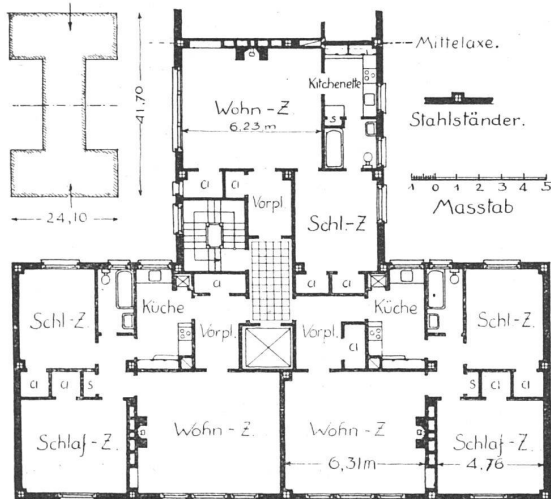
Grundriss eines Wohnhauses in New York. 12 Etagen mit je 6 Wohnungen von zwei und drei Zimmern. Übliche Stahlkonstruktion mit Backsteinfüllung. Links oben Plan des ganzen Baues. (Cl = »Closets, d. h. betretbarer Wandschrank.)
